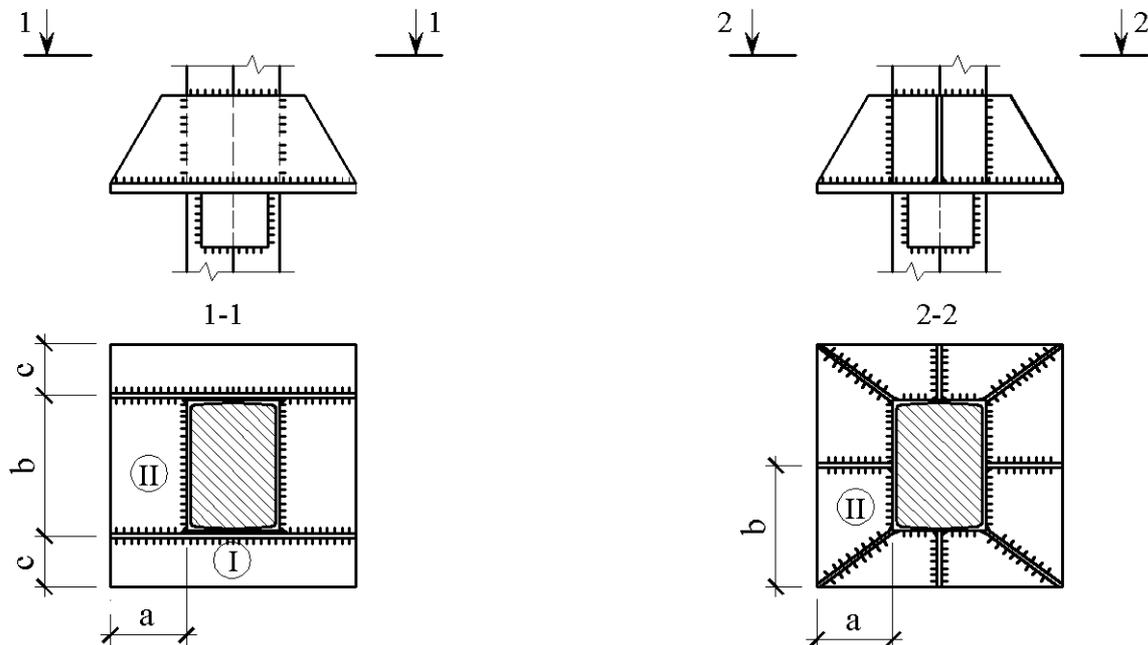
Опорні вузли плити на сталобетонну колону (монолітна залізобетонна плита умовно не показана)
